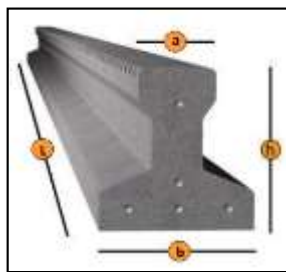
Losa Alivianada con viguetas pretensadas
